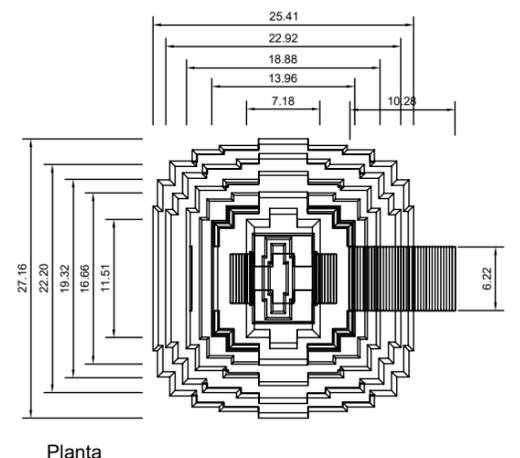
a: Planta arquitectónica del Edificio 1 Realizada. DECA 2018
